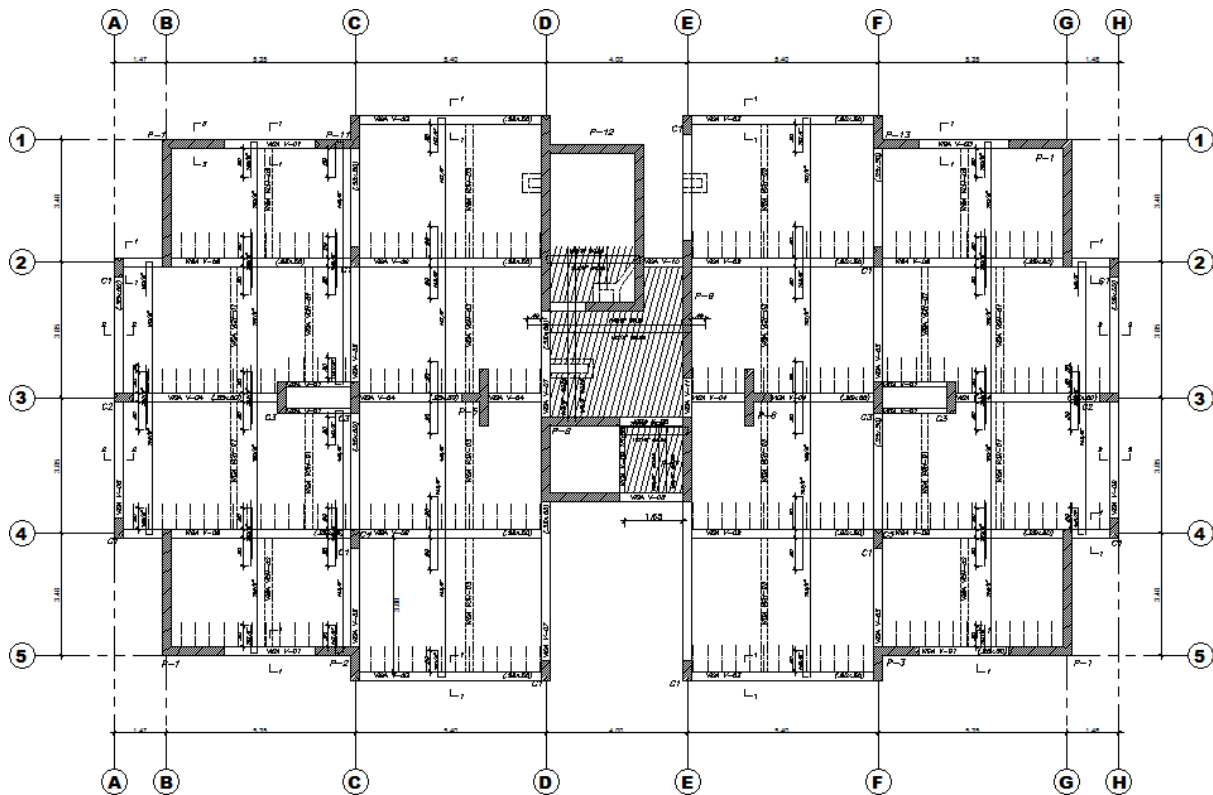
10. Plano de encofrados típico del edificio de 7 pisos
